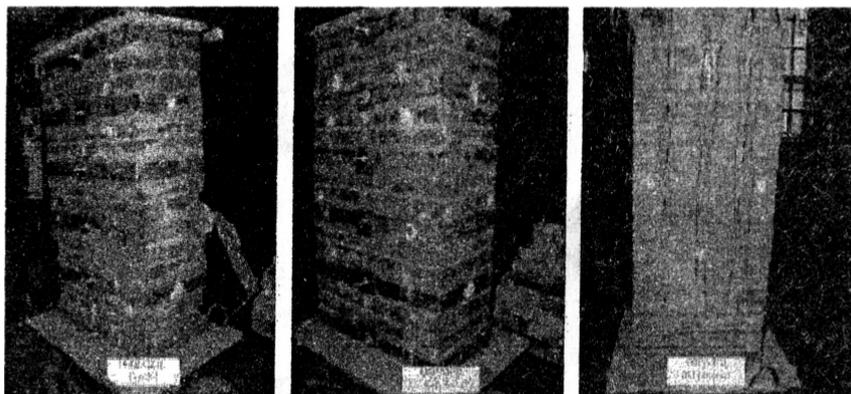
Испытание кирпичных столбов, усиленных внешним армированием (бандажами) из углеволокна
